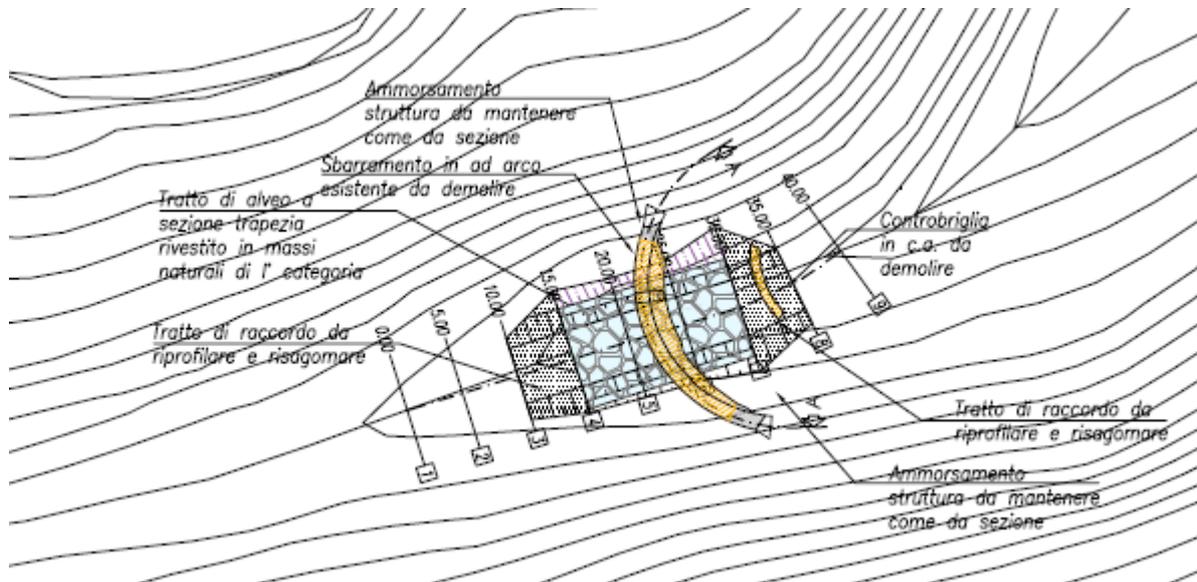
Planimetria con l'ubicazione dell'opera da demolire
